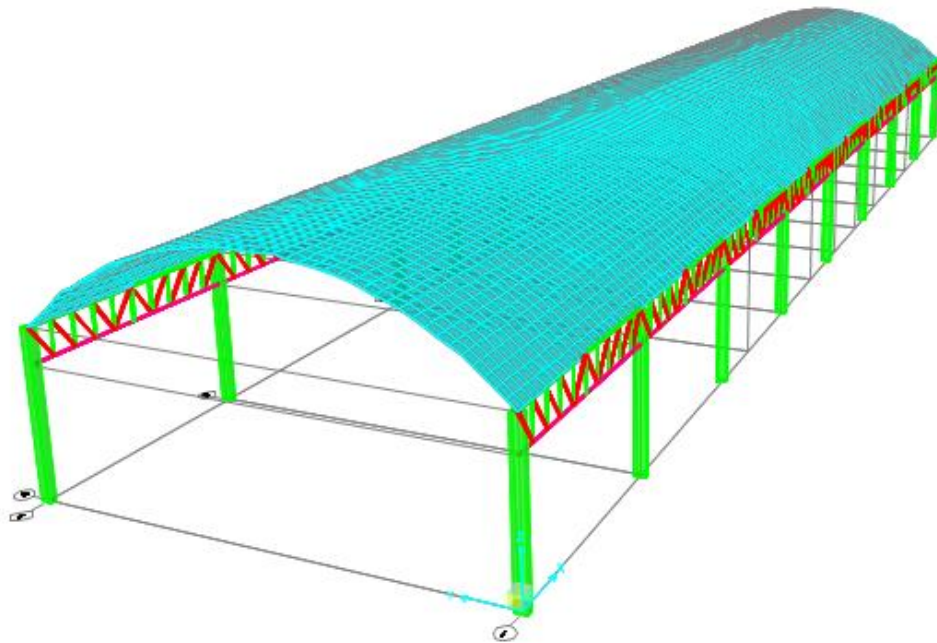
Vista general en 3D del sistema de cubierta, armaduras y columnas.
